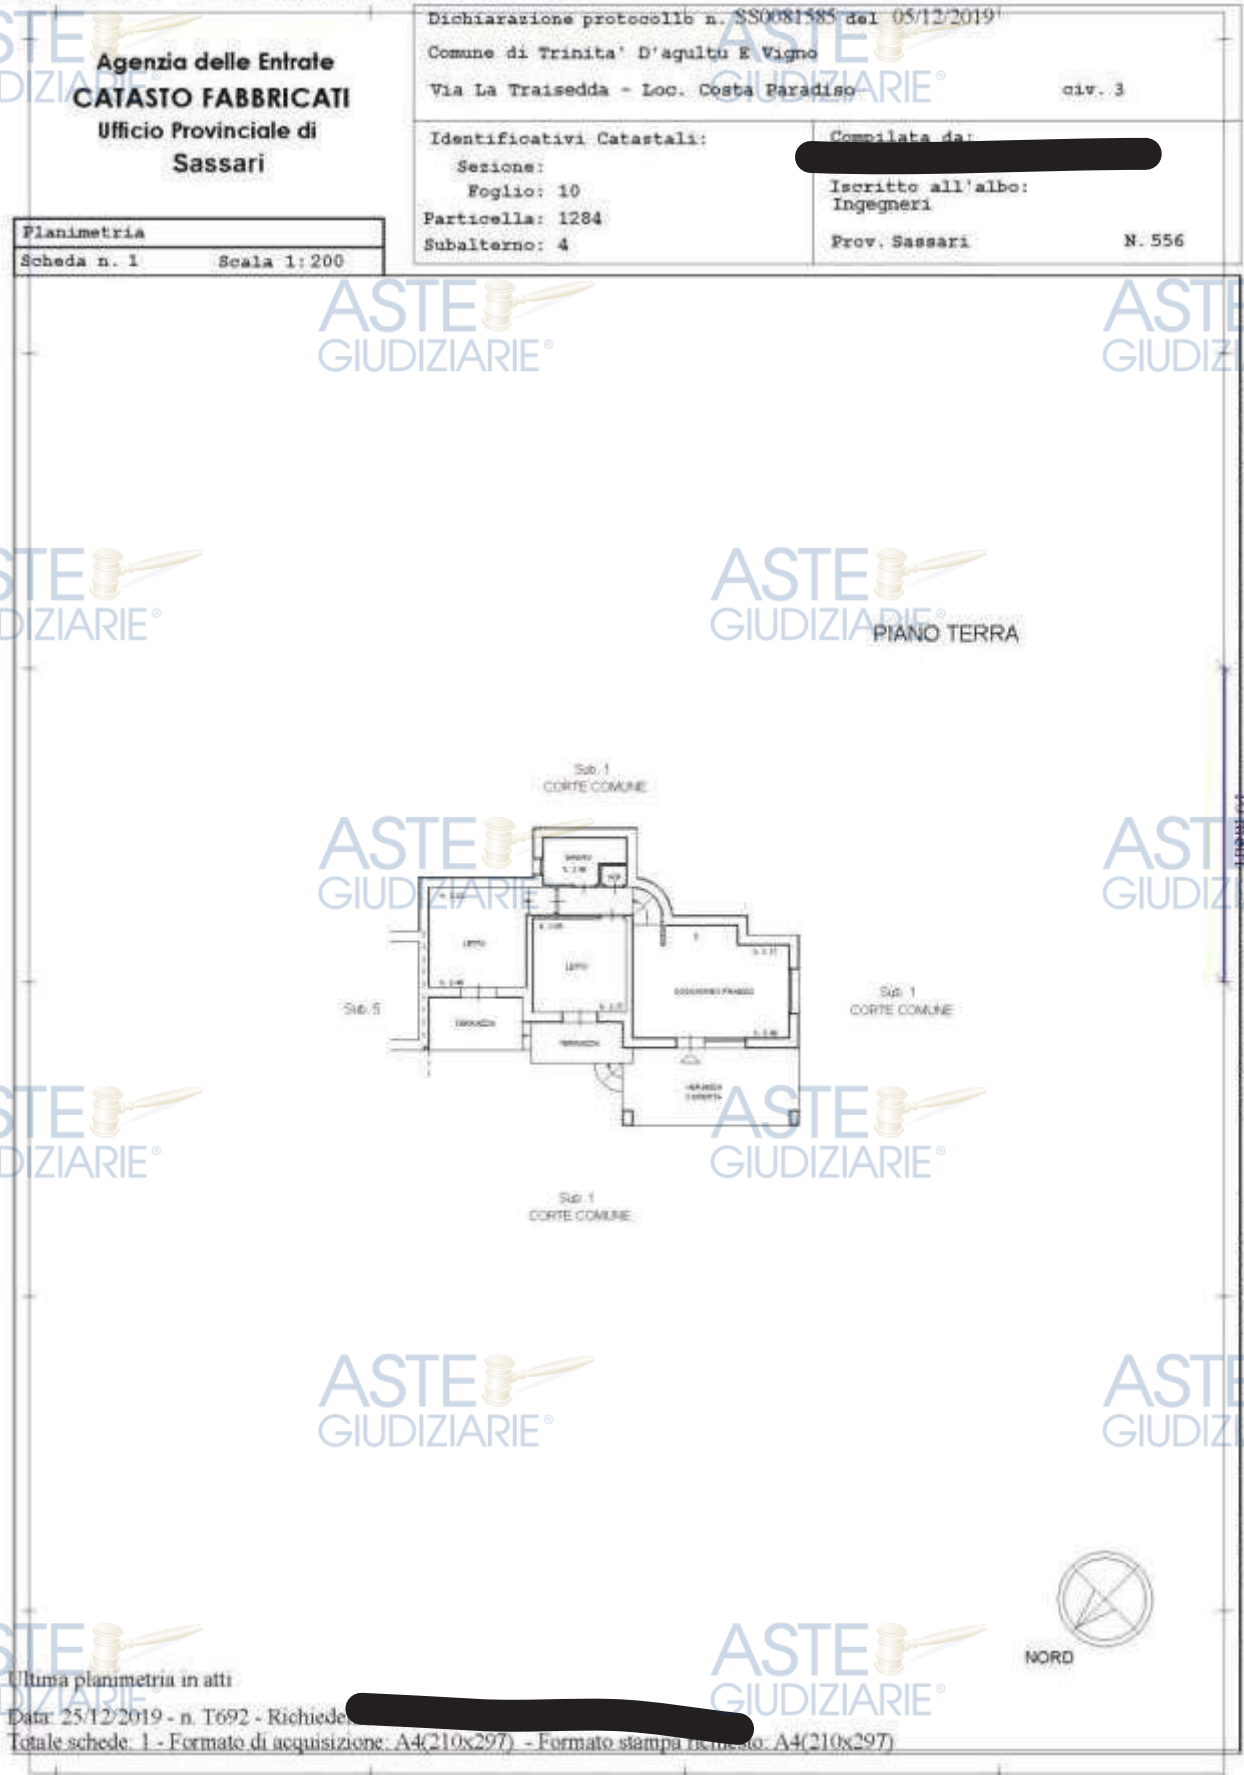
Visura planimetrica catastale aggiornata Fig. 10 Part. 1284 Sub 4
